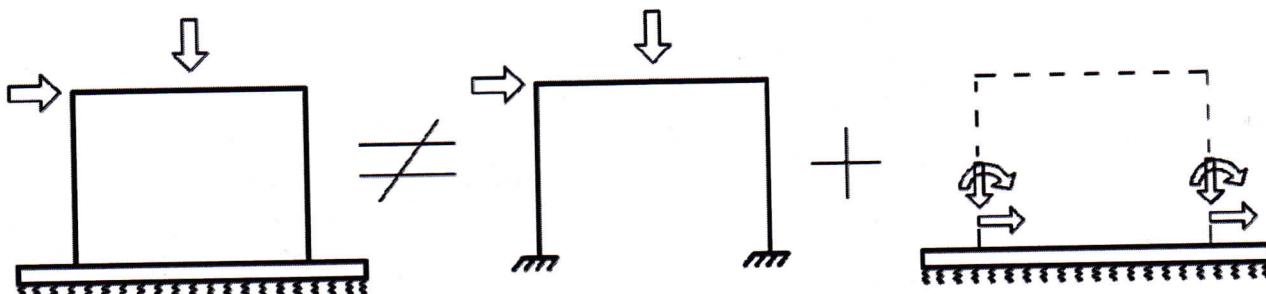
Учет совместной работы «надземное строение – фундаментная плита – грунтовое основание»
